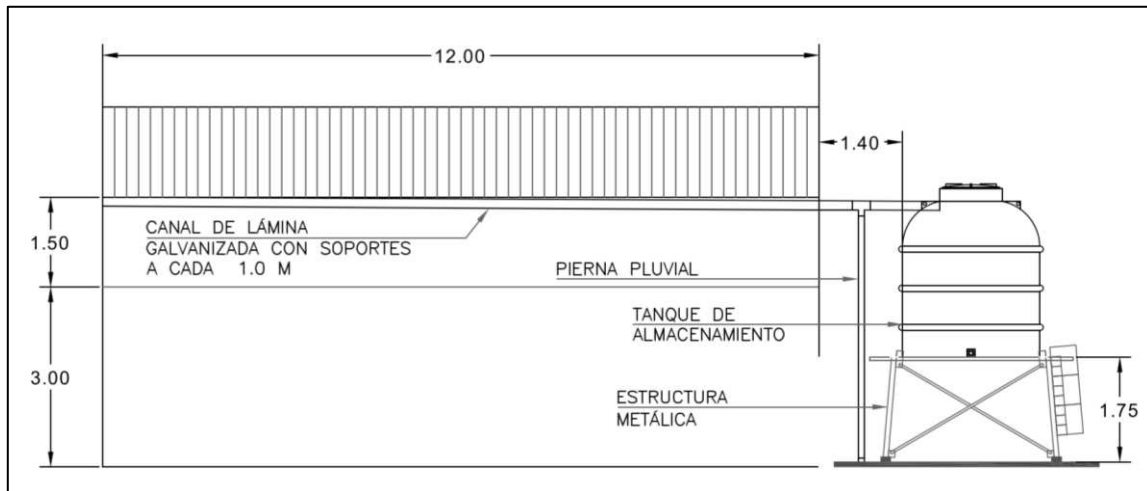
Propuesta de estructura metálica para elevación de tanque
